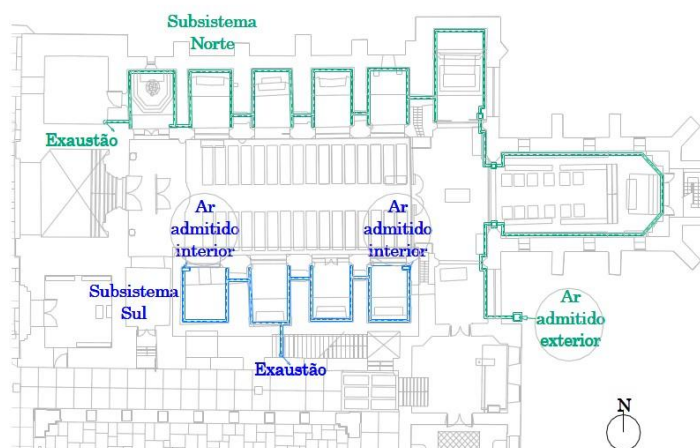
Planta com localização dos subsistemas de ventilação [34]
